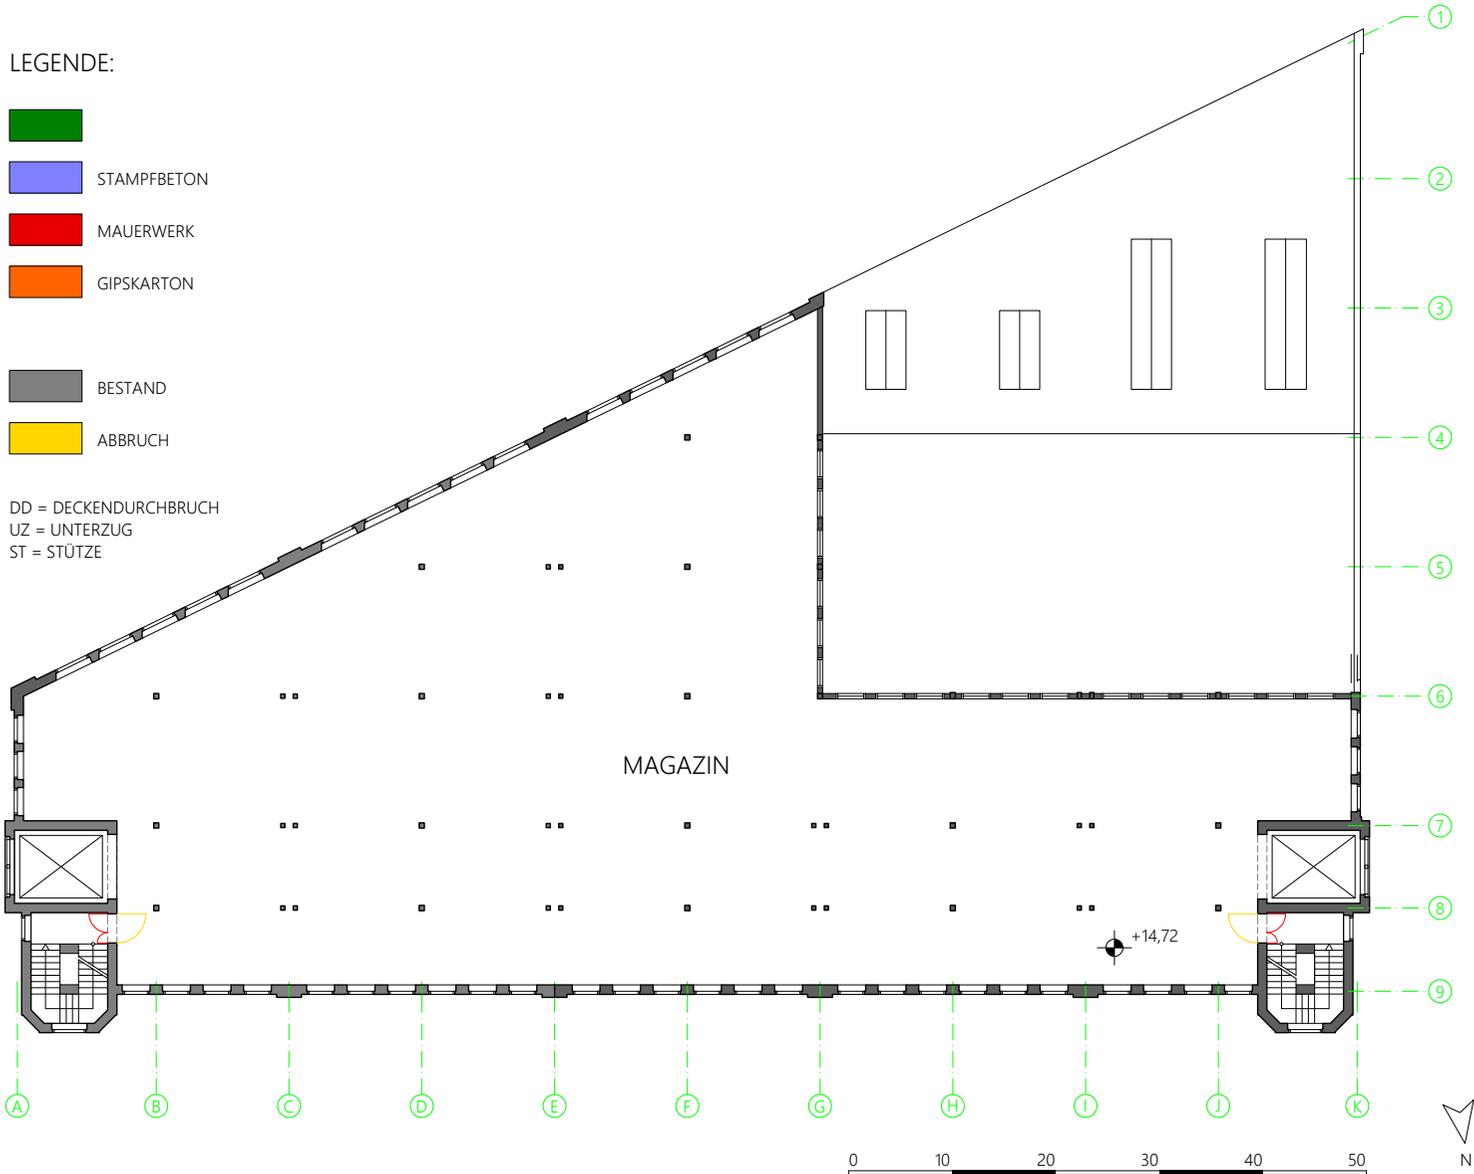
Bauphasenplan 2008: Dachgeschoß des Maschinenmagazins
